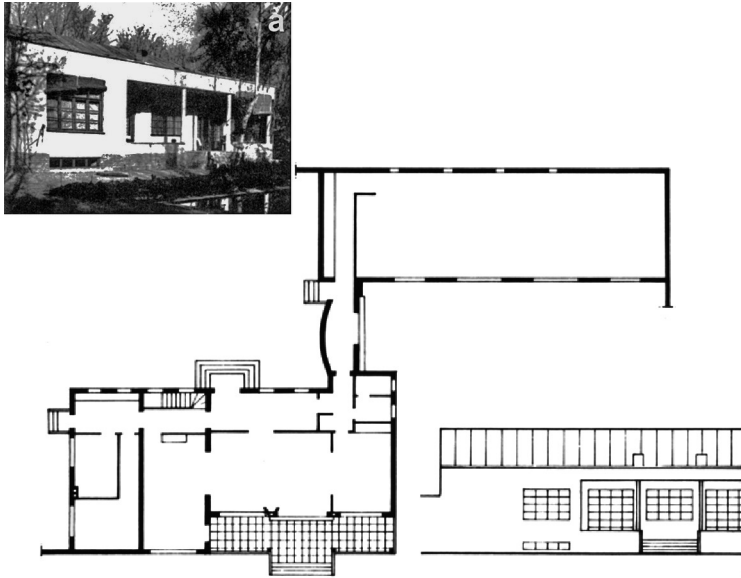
Villa Firouze, Teheran, Gabriel Guevrekian 1937. Foto Gartenseite, Grundriss, Aufriss Gartenseite.
